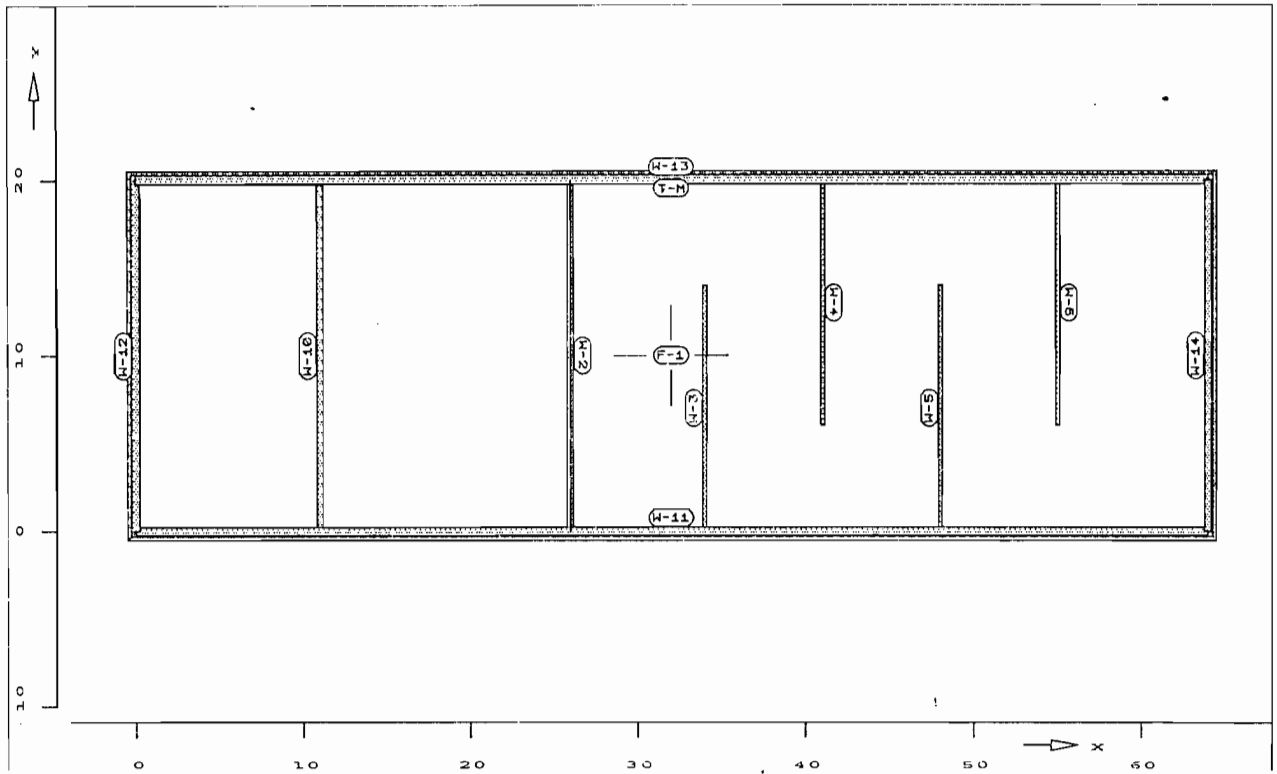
Vue en plan d'un bassin aérobie de 6.25 m de hauteur
